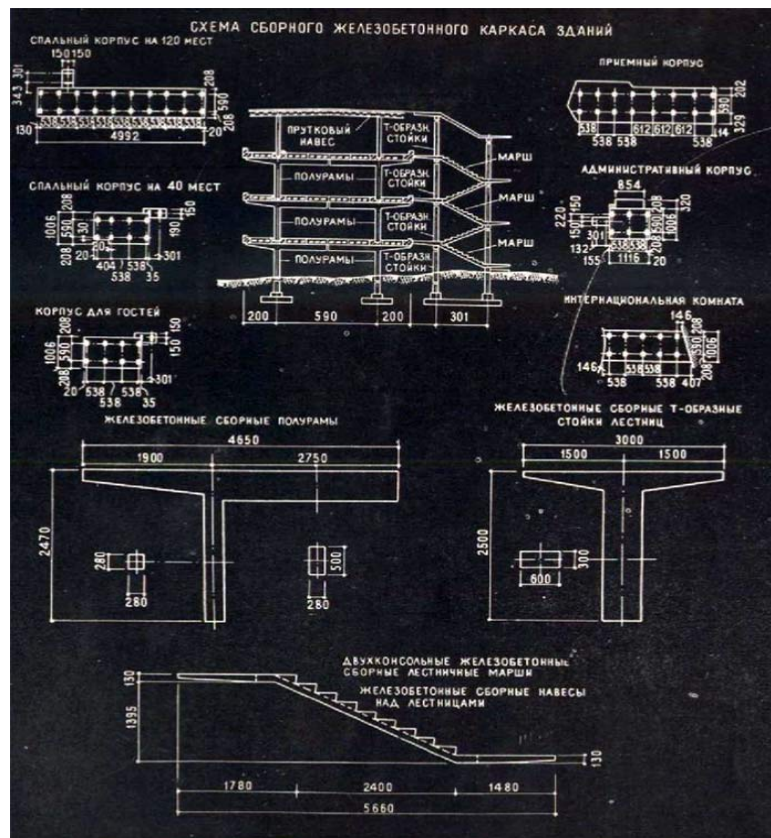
Схема сборного железобетонного каркаса зданий. Сост. Е. Гладких
